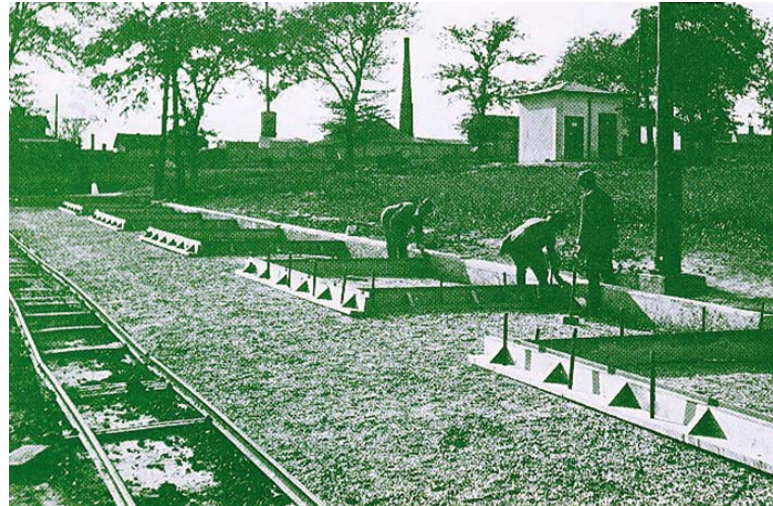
Erster Betonstraßenbau in Wien (1927)
